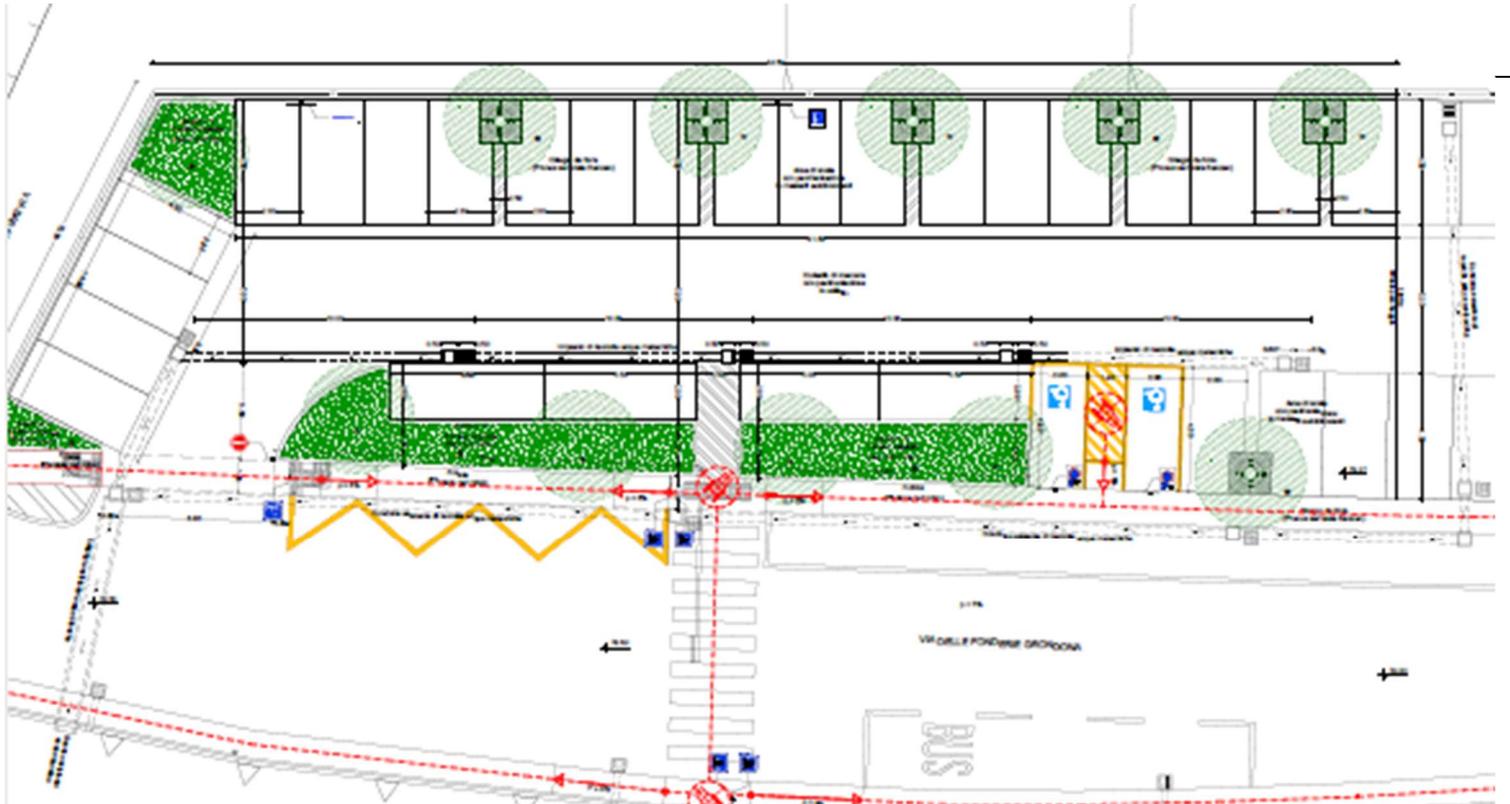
Progetto Planimetria superamento barriere architettoniche (Tav. E.AR.15)
